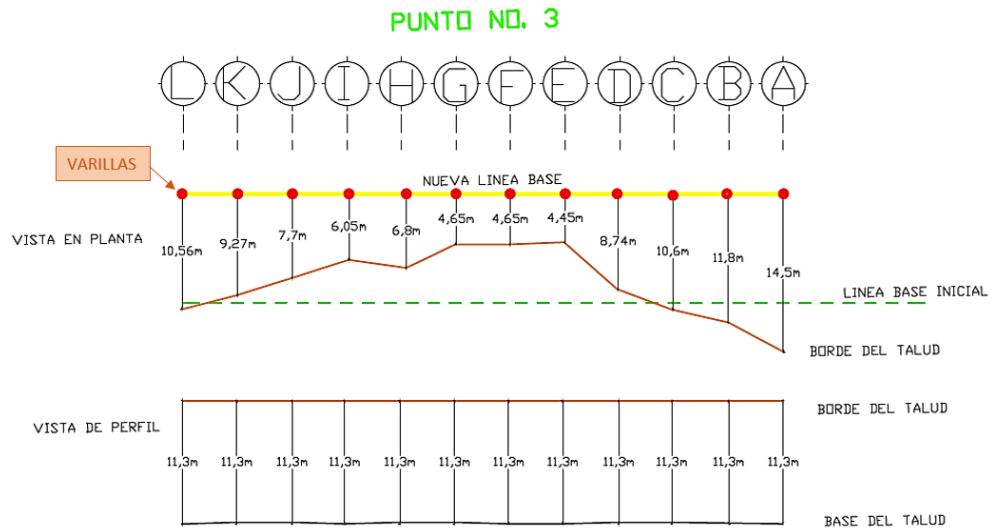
Dimensiones en planta y en perfil finales del PUNTO No.3 TALUD AEROPUERTO II
